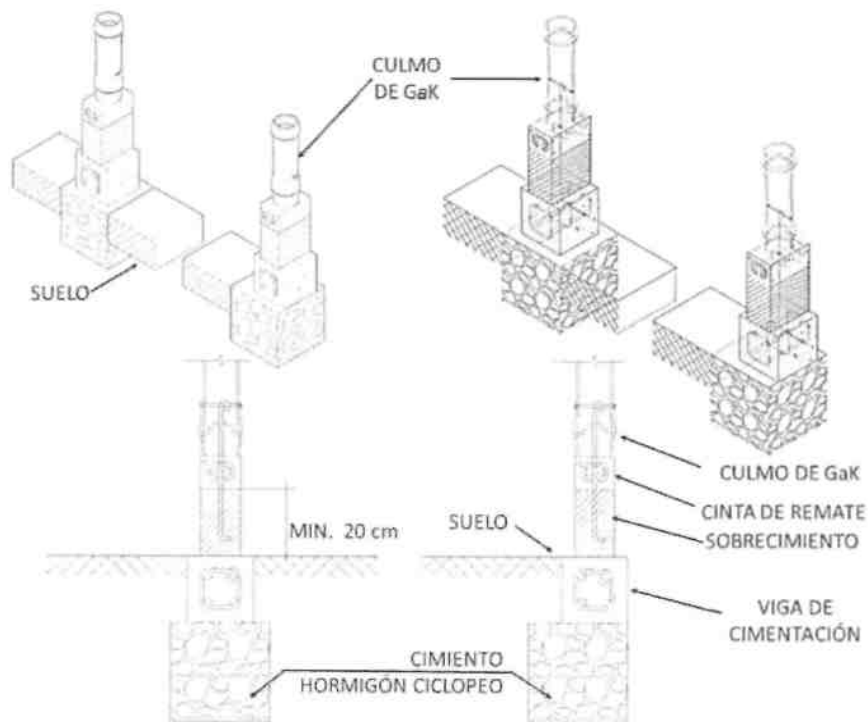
Detalle de cimiento y sobrecimiento (Viga de cimentación)
